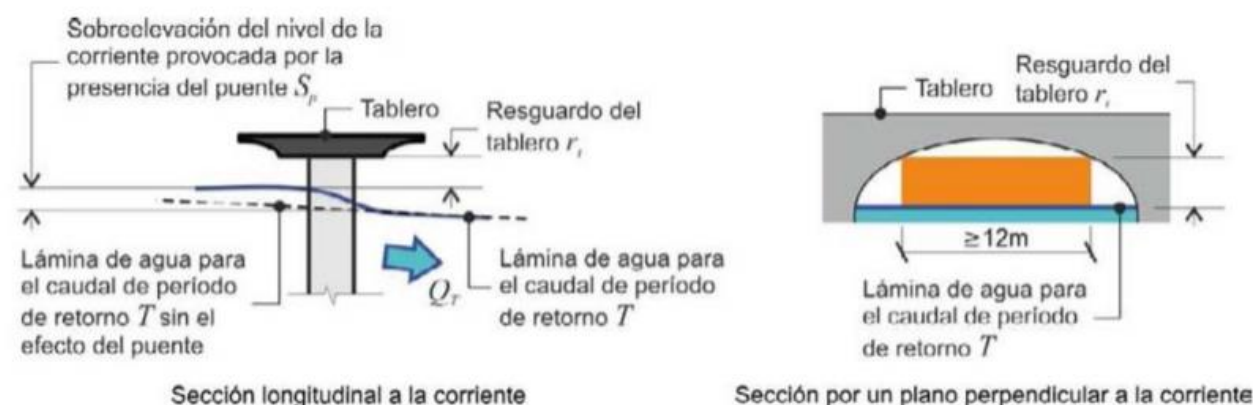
Instrucción de carreteras 5.2.-IC "Drenaje superficial" (Orden FOM/298/2016).
